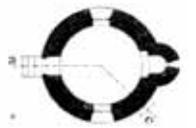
Grundriss Gruber 1924. M 1:400.
